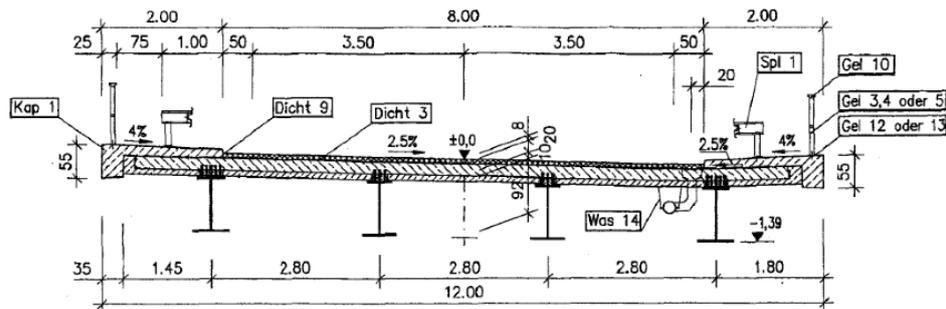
Brückenquerschnitt: Fertigteile mit Ortbetoneergänzung
